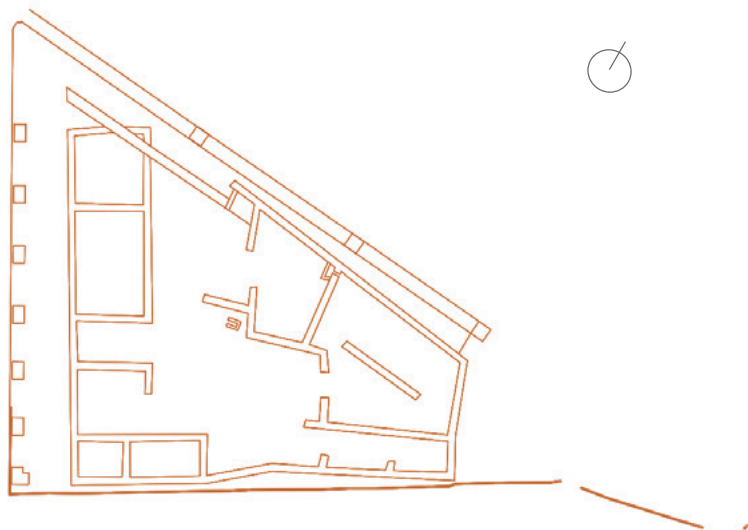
Plano del estado actual del edificio triangular (fuente: R. Angulo, 2009. *Elaboración de las fichas diagnóstico de los bienes inmuebles del CAI*)
